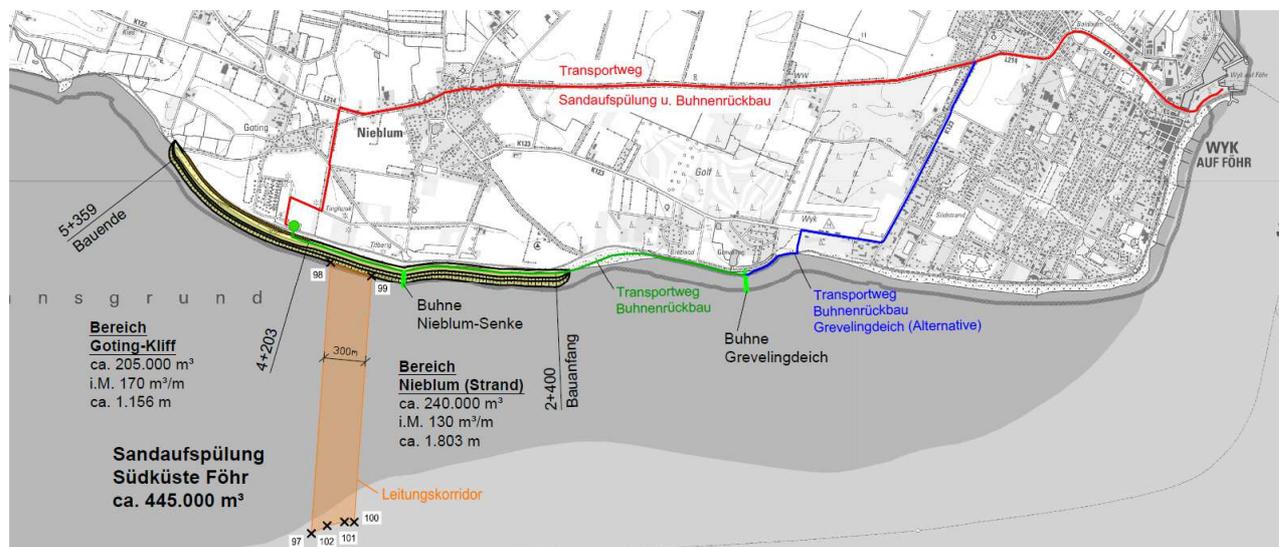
Lageplan Sandaufspülung Nieblum (Strand) und Goting-Kliff
